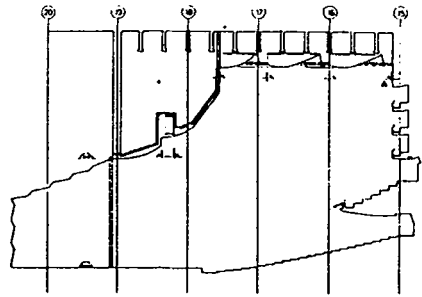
Coupe longitudinale - Plafond position Concert
